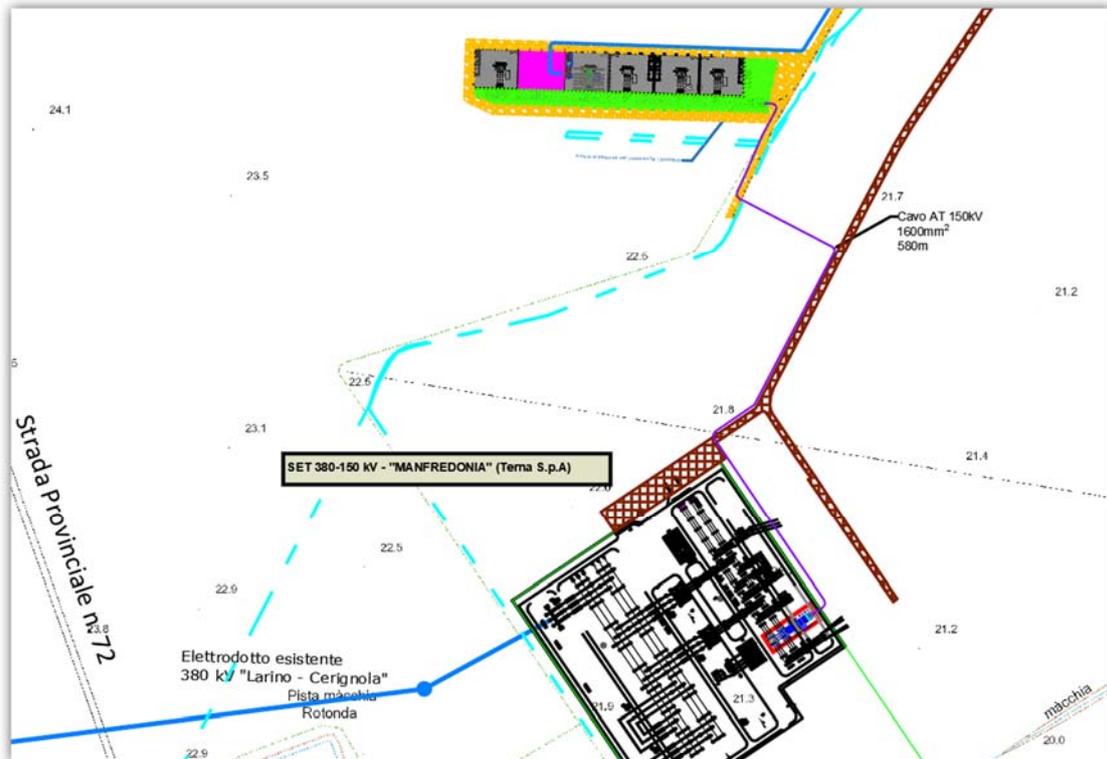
Stralcio planimetrico con evidenza della posizione reciproca dell'area delle Sottostazioni Produttori e della Stazione di Rete TERNA "Macchiarotonda", con il cavidotto interrato AT 150kV (in viola), e la posizione del futuro stallo AT in area TERNA (riquadro rosso)
